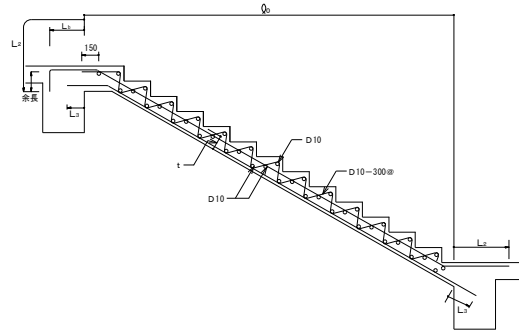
二辺固定スラブ形階段配筋 (その 1)
